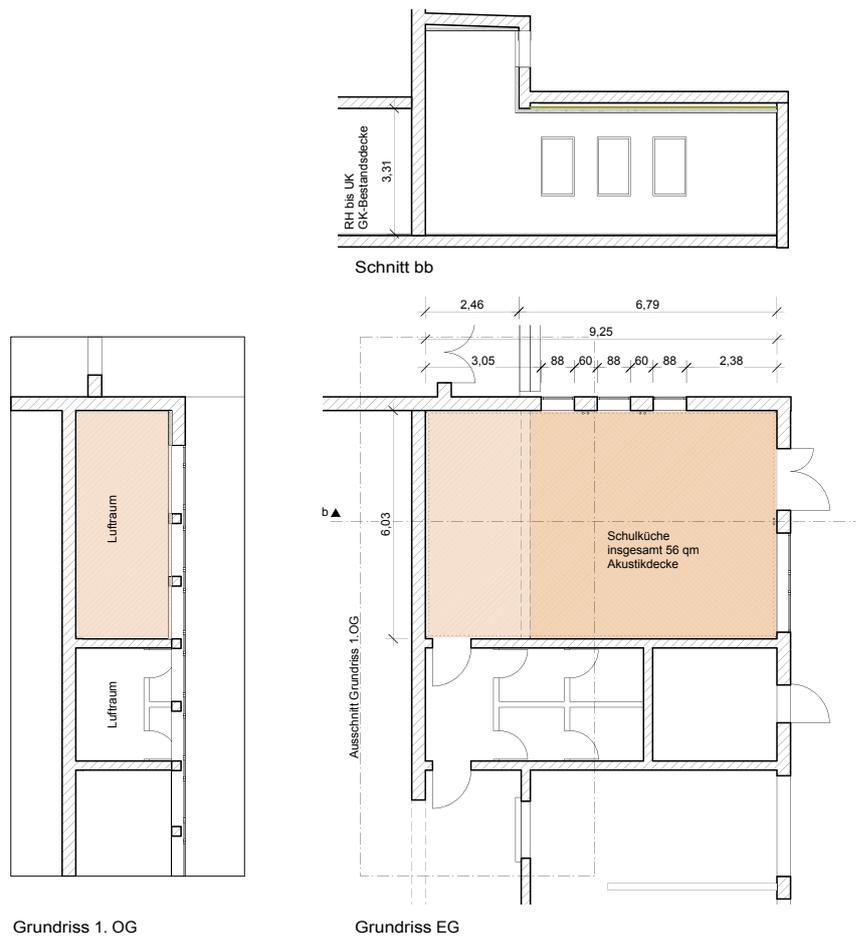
Grundriss Schulküche, M 1:150
